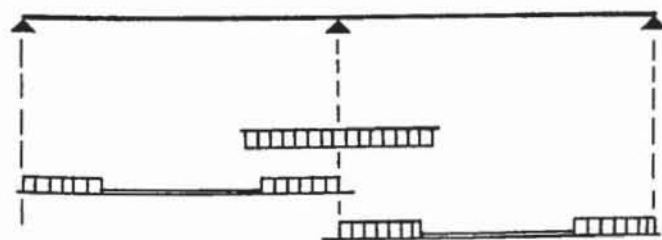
Matte mit Schubleitern, Bewehrung einer Platte
